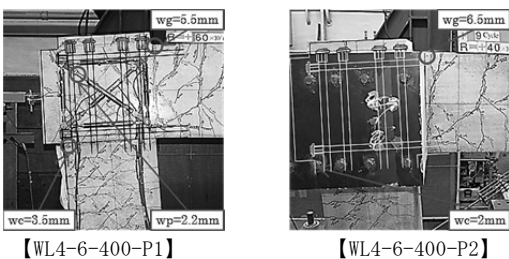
系列IIのひび割れ状況 (R=60×10<sup>-3</sup>rad時)
